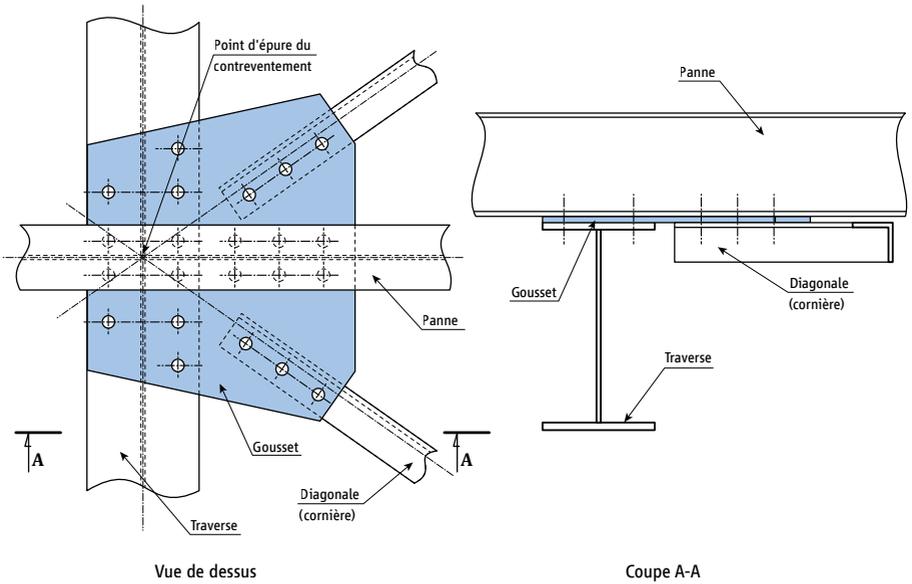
Détail d'un nœud d'assemblage de poutre au vent
